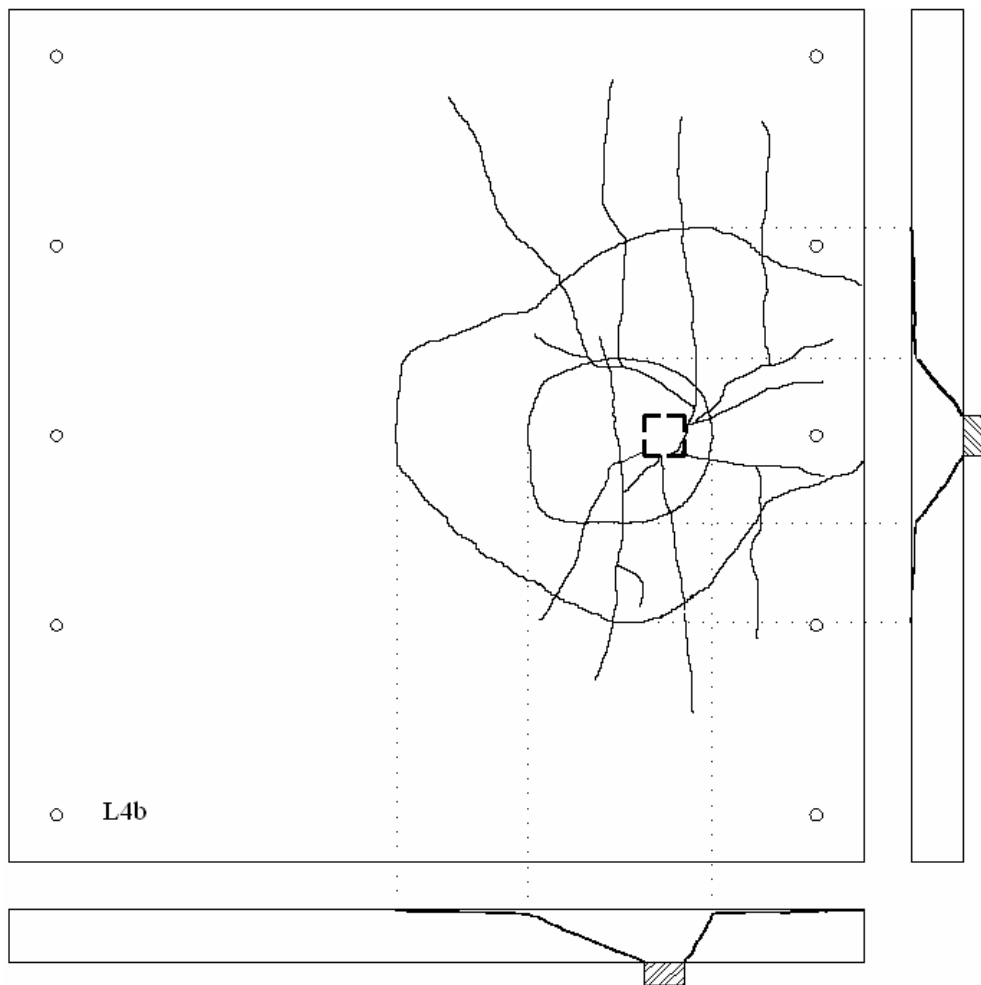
Mapa de fissuração da laje L4b
